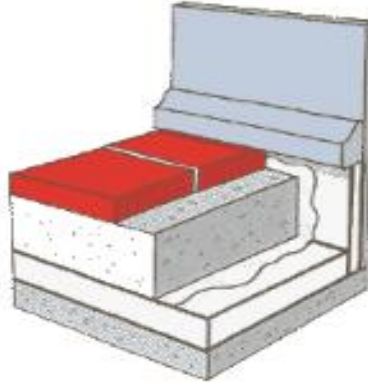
Isolamento de poliestireno expandido sob o pavimento flutuante [19]
